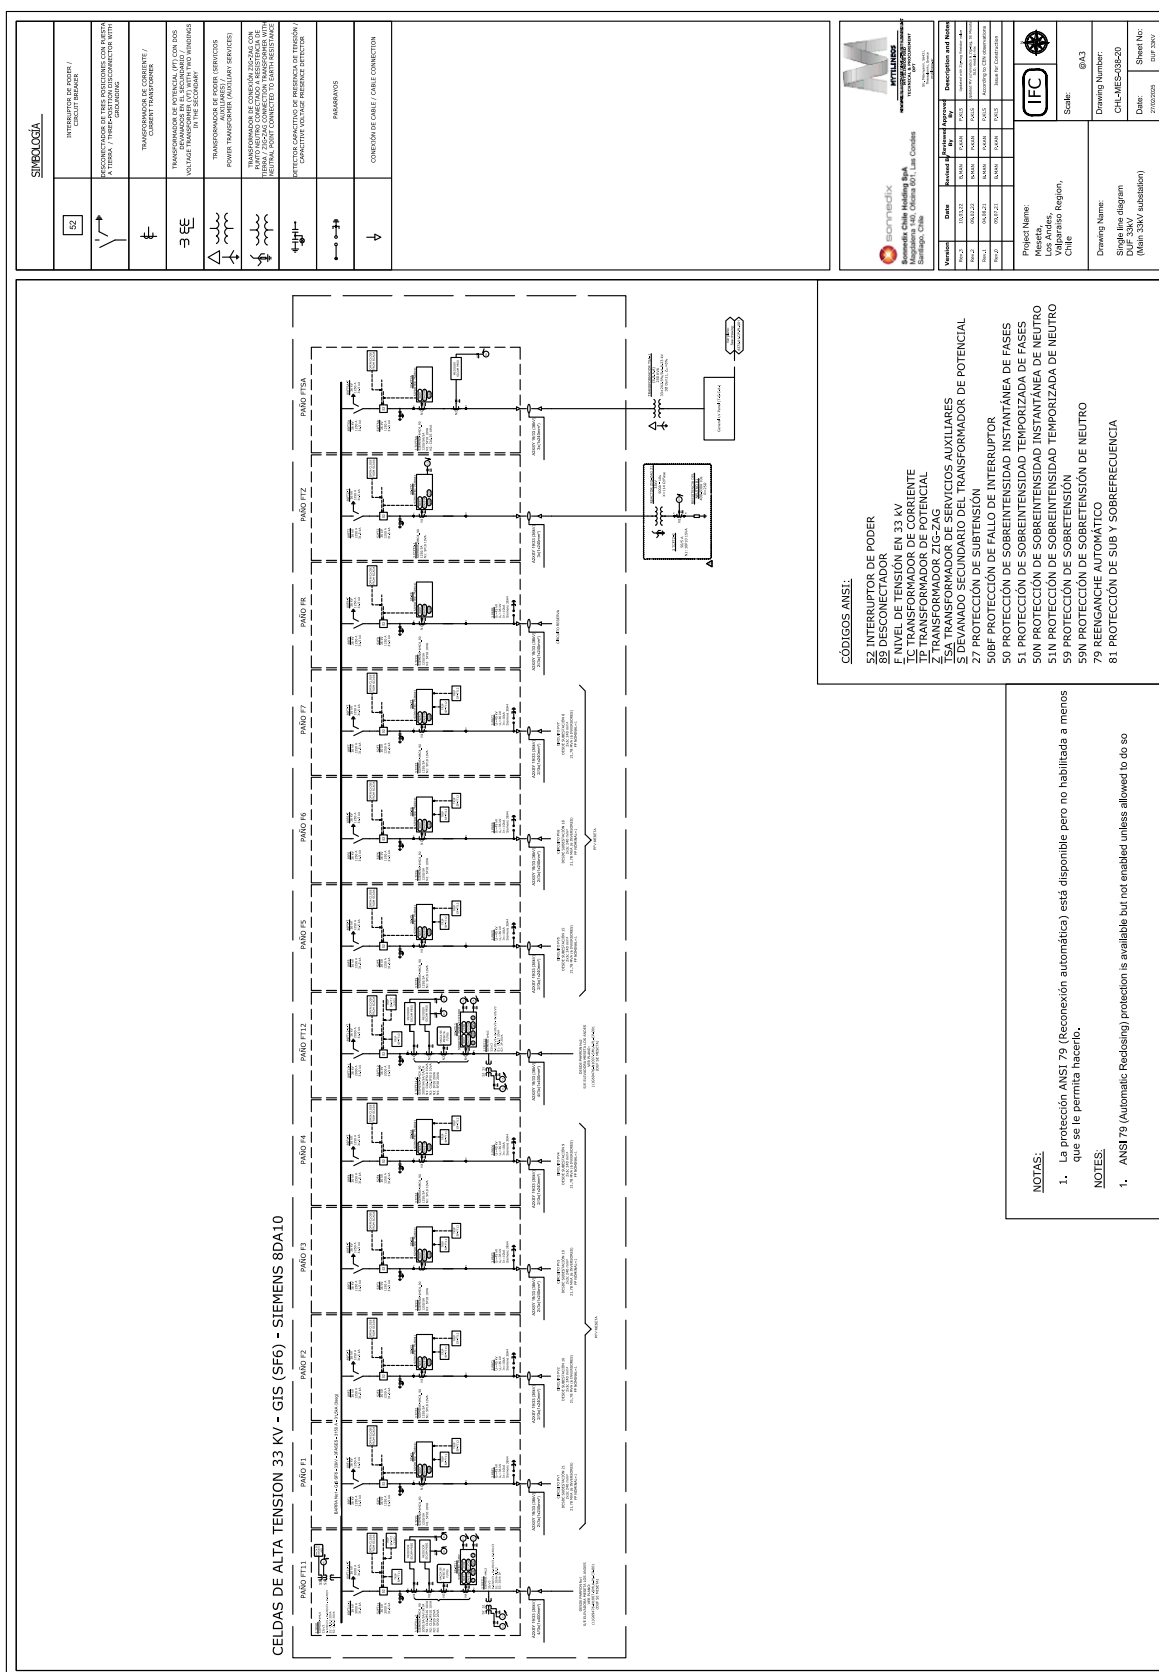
Unilineal general de la planta (lado de 33 kV)
